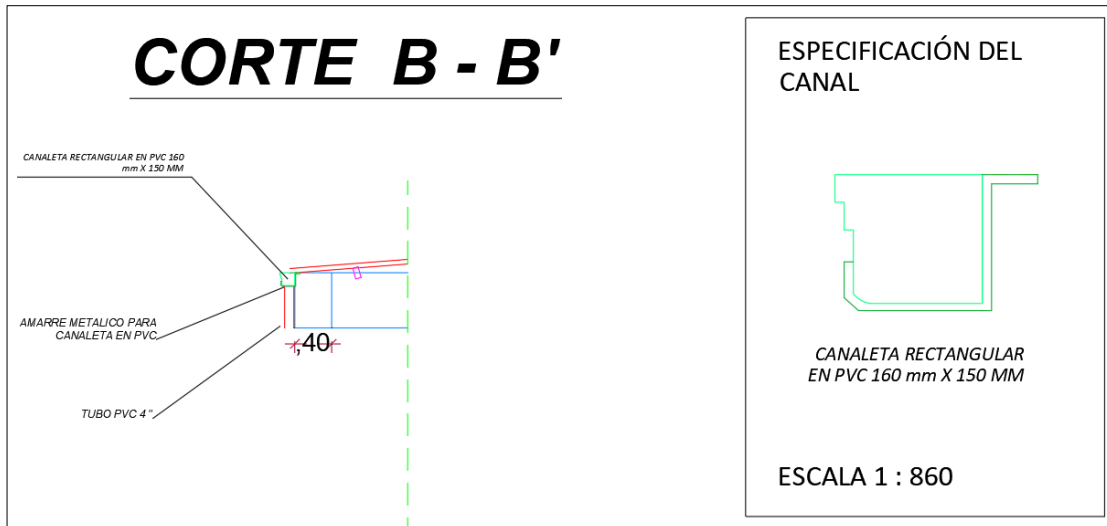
Corte arquitectónico B-B', de la estructura 2 del Centro de Desarrollo Infantil.
